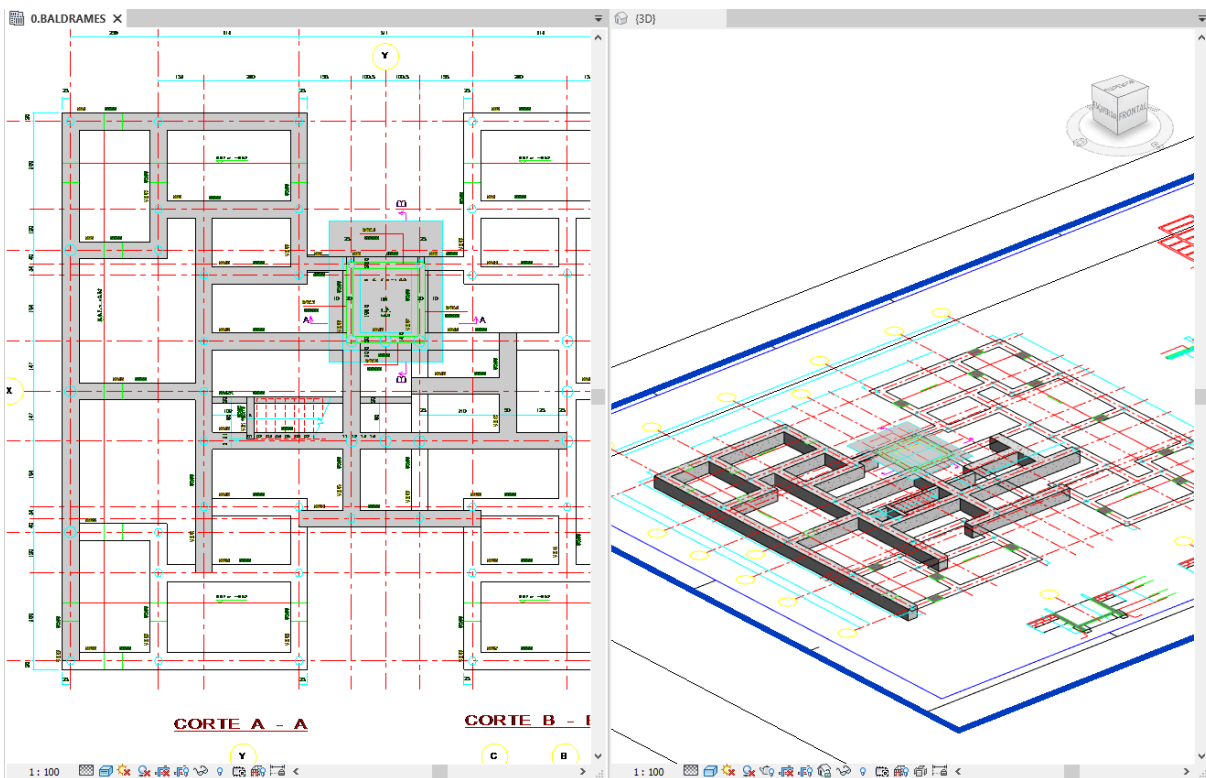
Base em 2D e modelagem das vigas baldrame.
